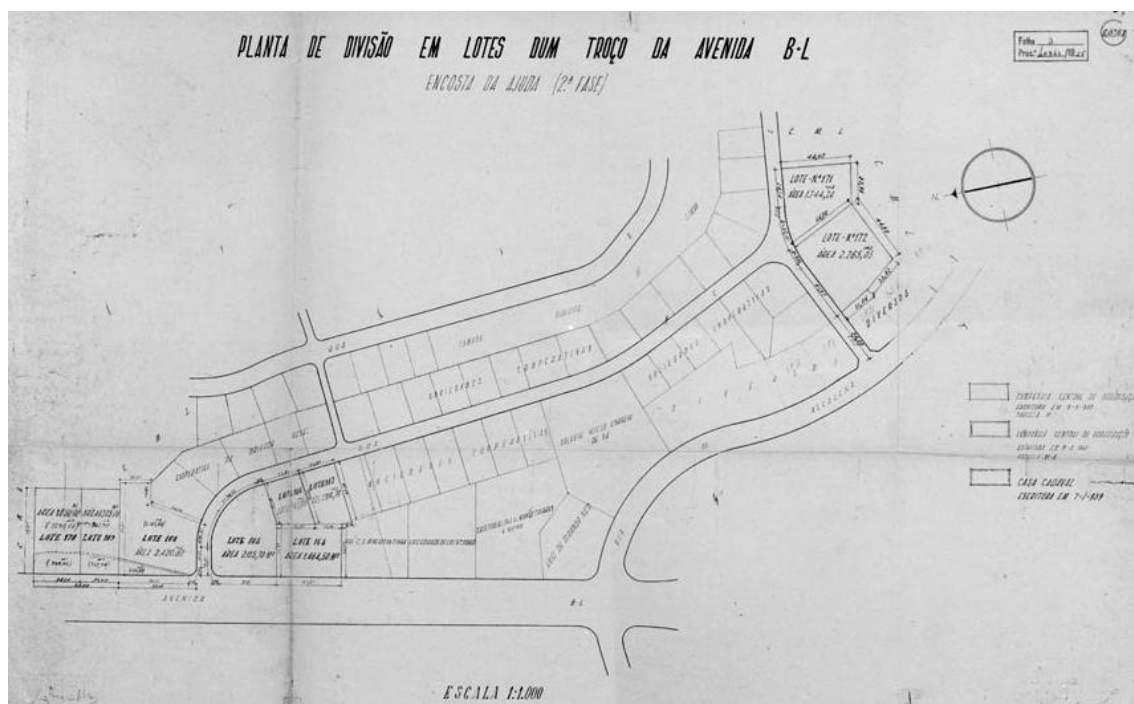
Planta de divisão em lotes dum troço da Avenida BL (actual Avenida das Descobertas)⁶⁷⁶
